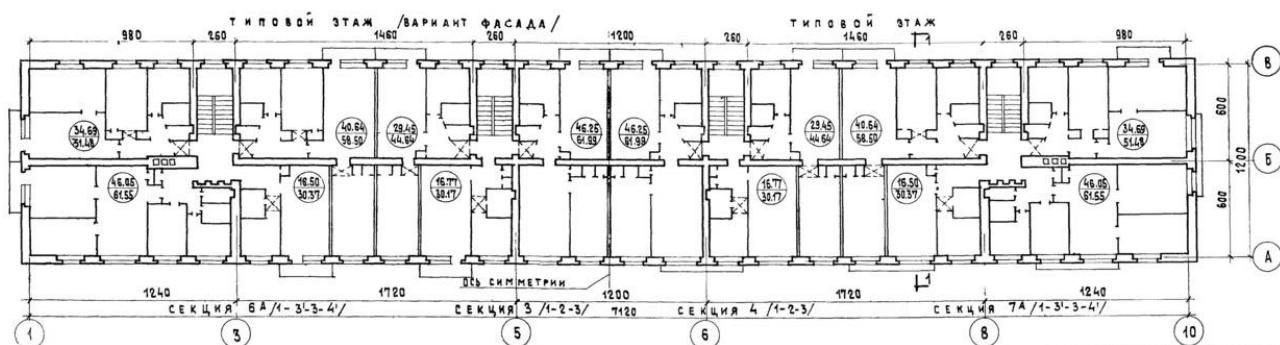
Планировка типового этажа серии 1-447С-43
